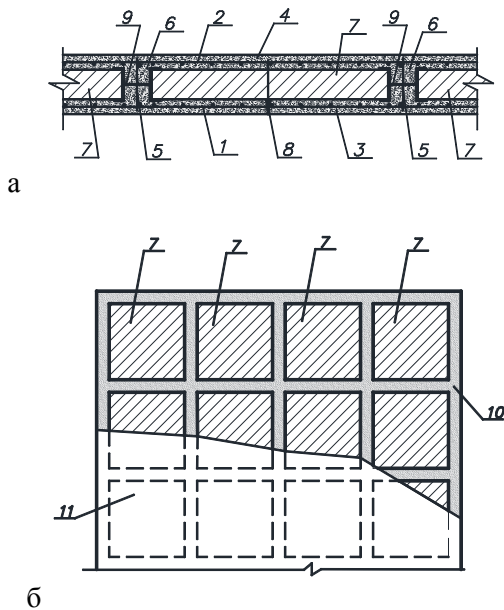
Способ устройства облегченного железобетонного перекрытия: а – поперечное сечение перекрытия; б – последовательность бетонирования перекрытия; 1, 2 – арматура нижней и верхней сеток; 3 и 4 – нижняя и верхняя обшивка; 5 – арматурные каркасы; 6 – ребра перекрытия; 7 – вкладыши; 8 и 9 – фиксаторы; 10 – зазор между вкладышами; 11 – бетонирование верхней части перекрытия
